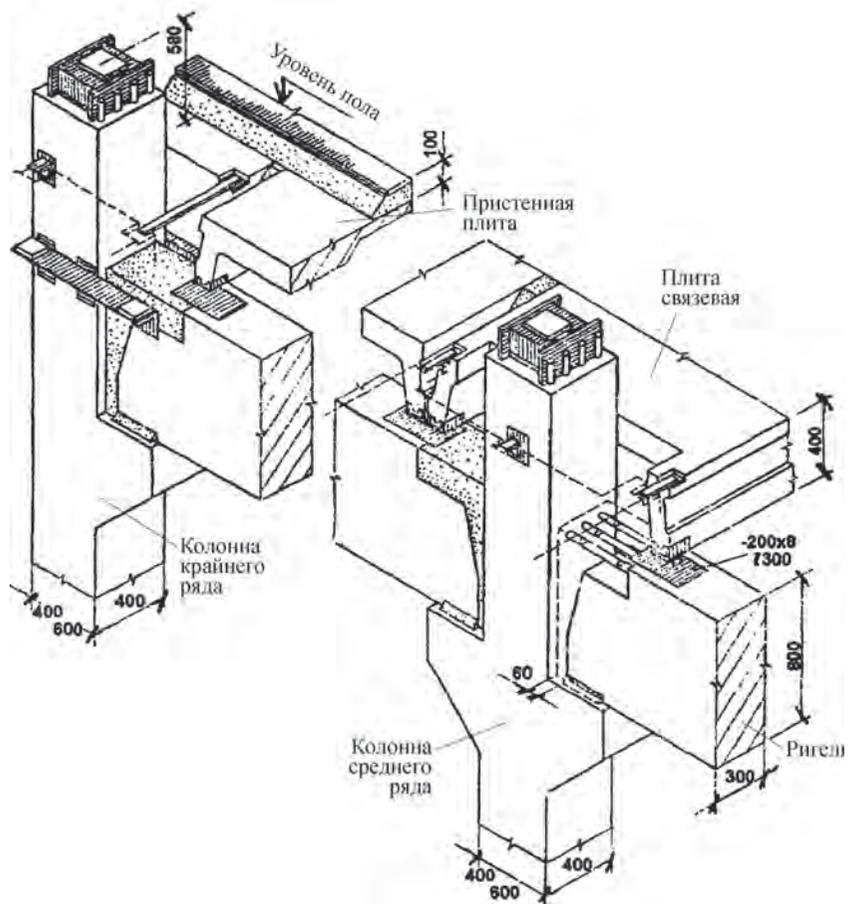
Опираие плит перекрытий по верху ригелей (рамная схема, жесткое соединение ригеля с колонной)
